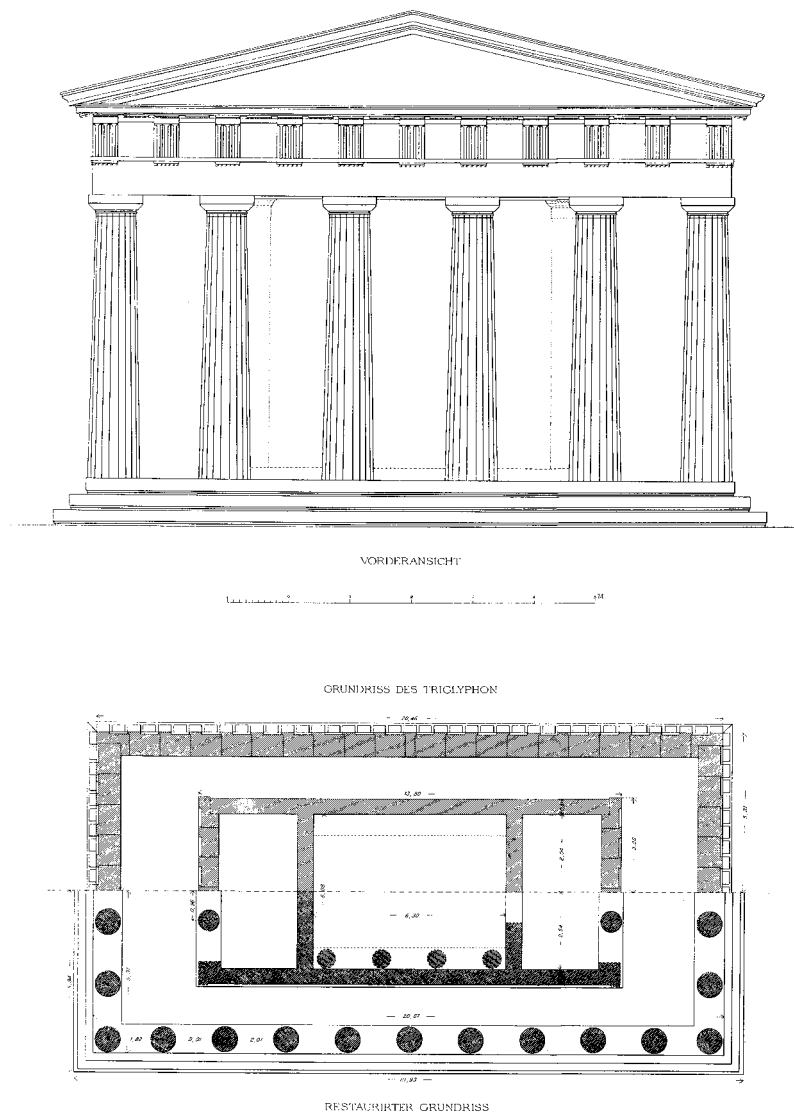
Olympia, Metroon, rekonstruierte Ansicht und Grundriss
